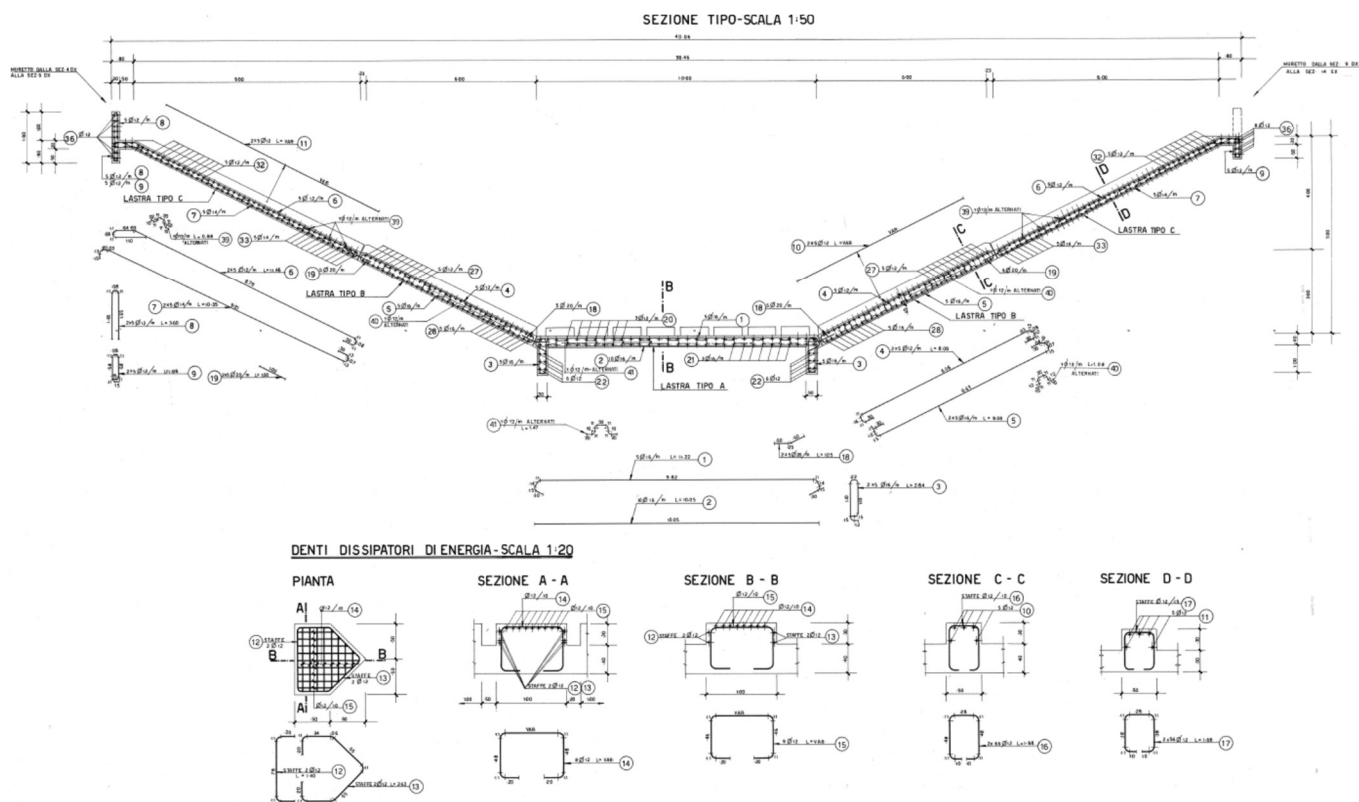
Progetto esecutivo del 1983 – Sezione tipo armata
